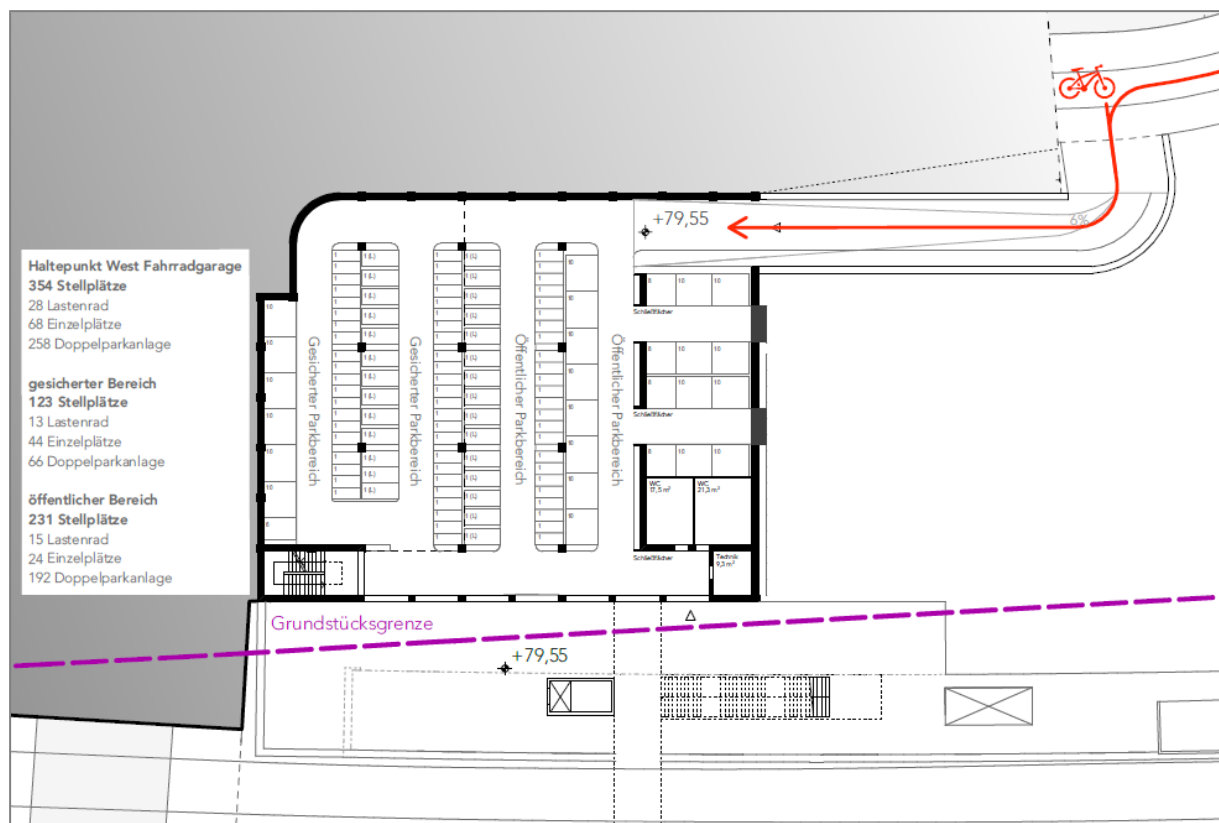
Grundriss vom Fahrradparkhaus (Giesler Architekten)
